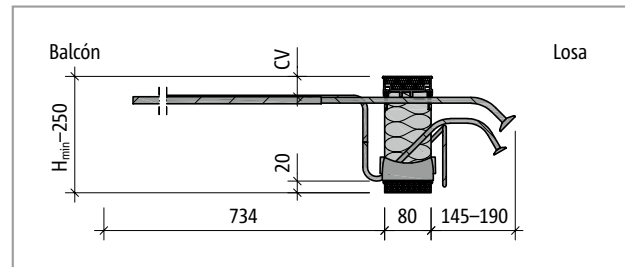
Schöck Isokorb® T tipo K-O-M4: Sección del producto
